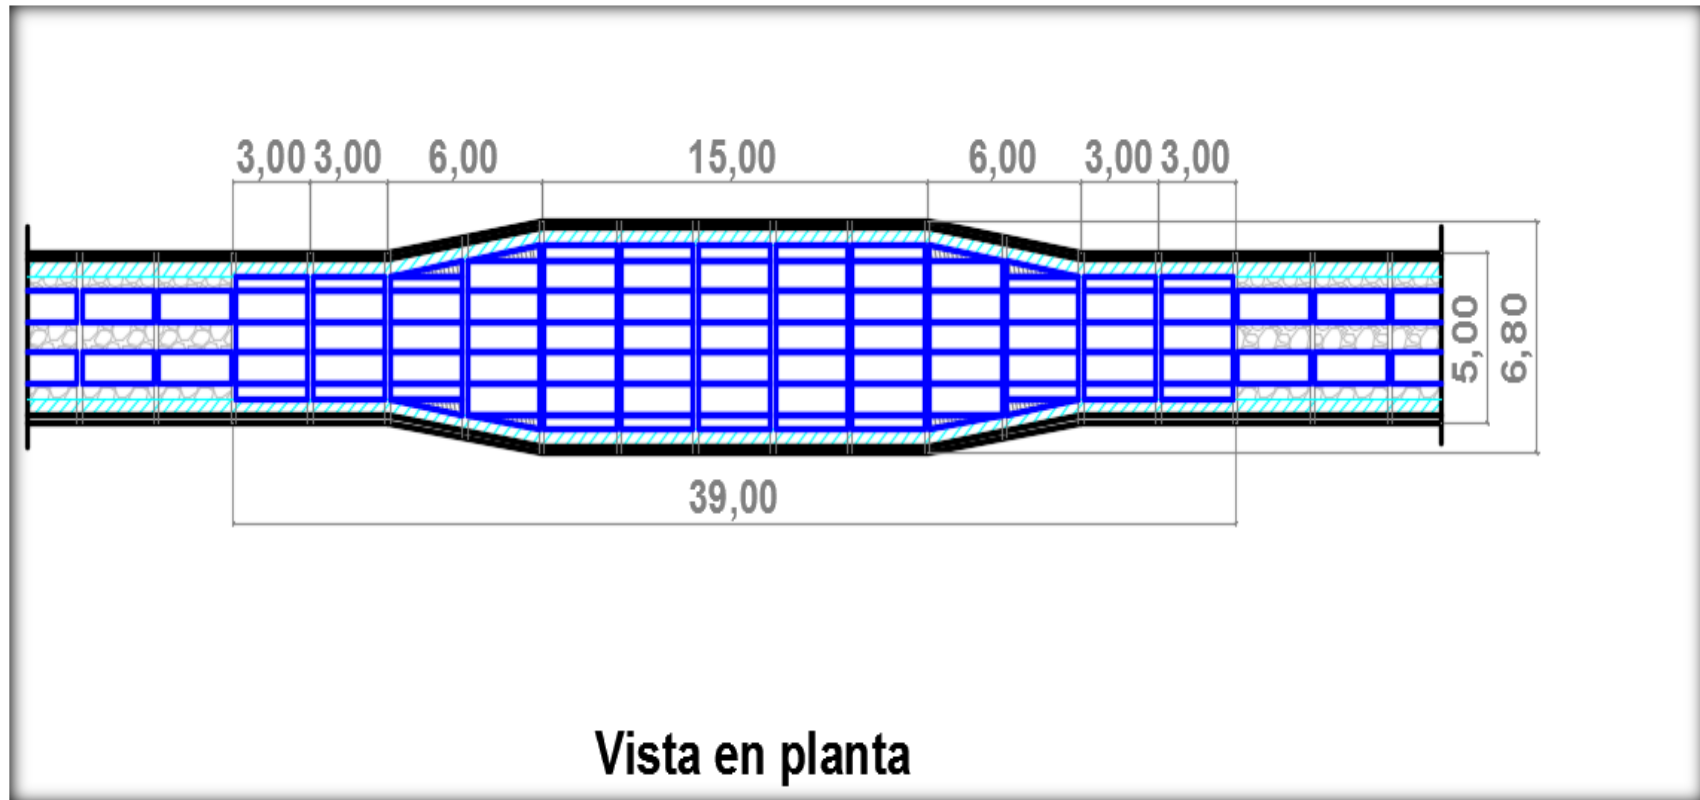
Diseño Propuesto para Zonas de Cruce 4 Carriles. Vista en Planta
